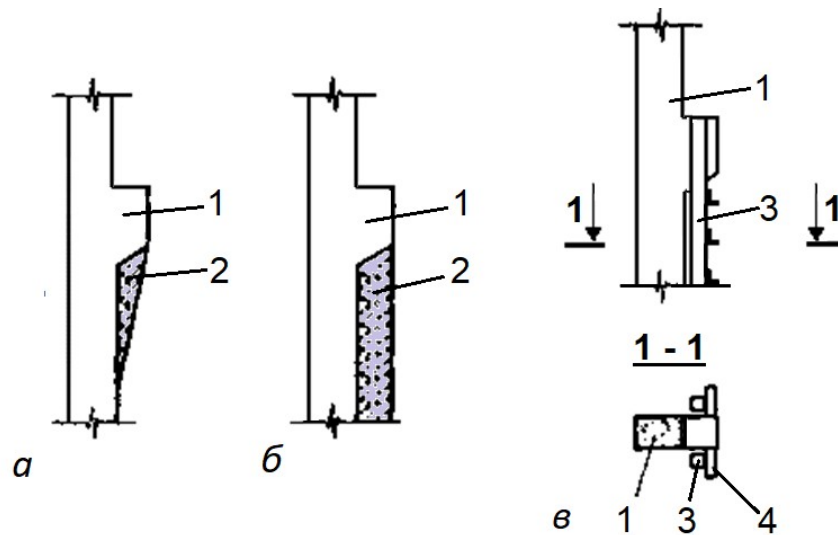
Схема підсилення колони металевою обоймою із попередньо напруженими стійками:
